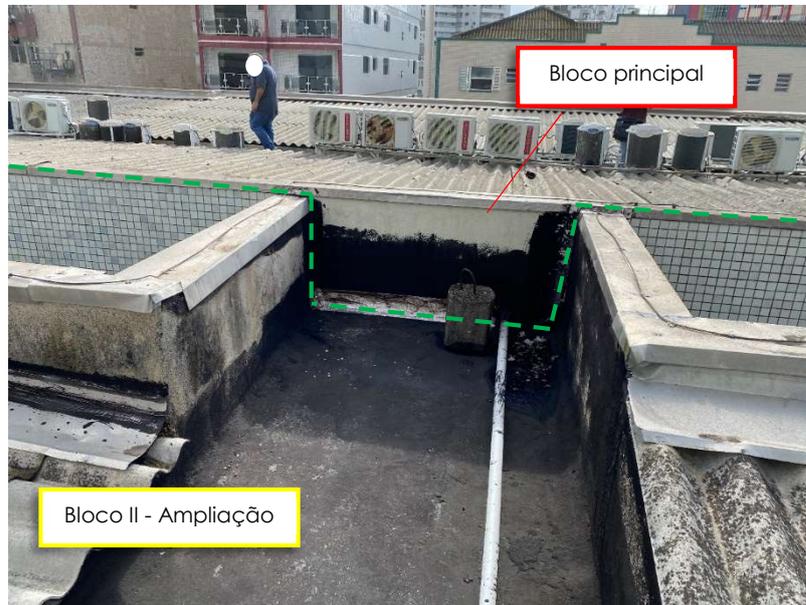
Vista da laje de cobertura da passarela do segundo pavimento, com o observador olhando para o bloco principal.
